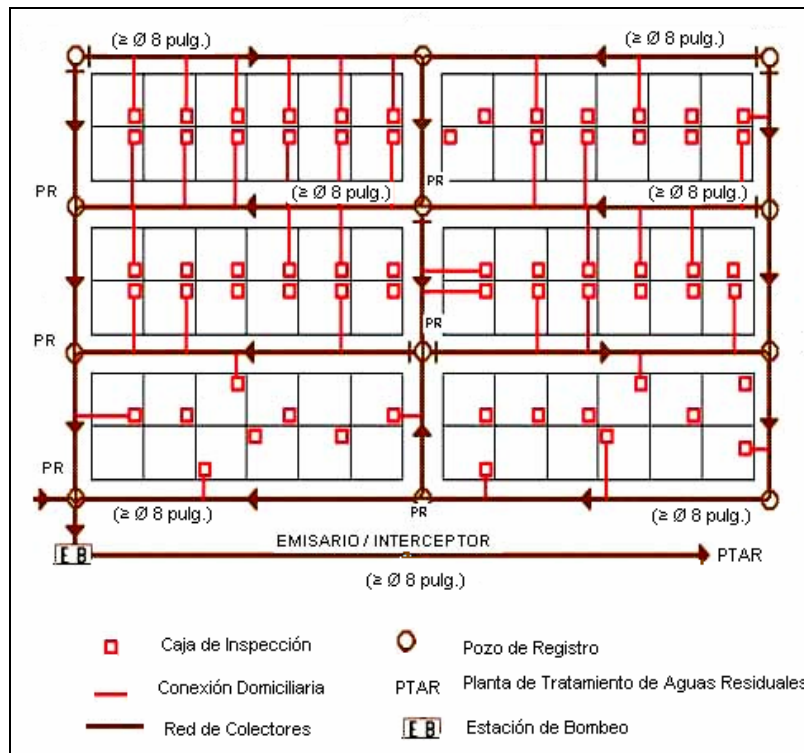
Esquema de un sistema de alcantarillado convencional.
